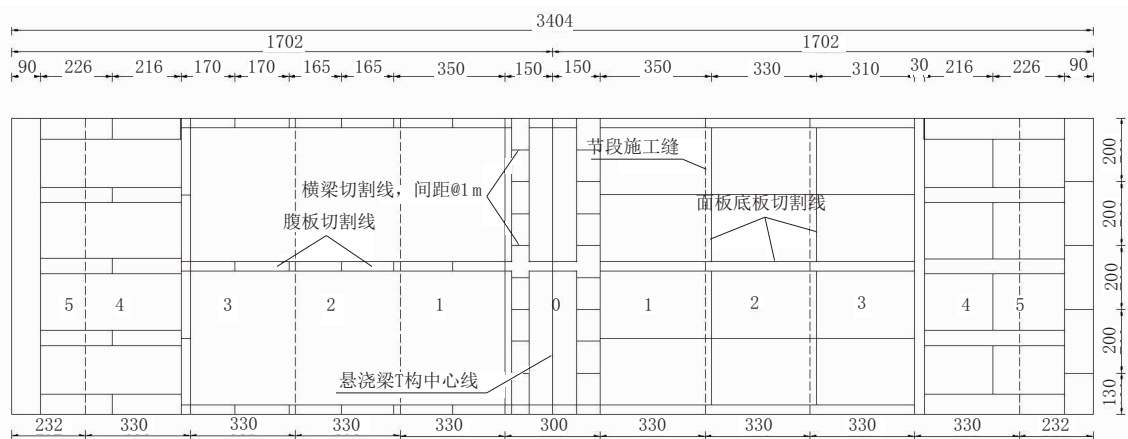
T构箱梁切割混凝土块吊装孔平面布置图(单位:cm)
